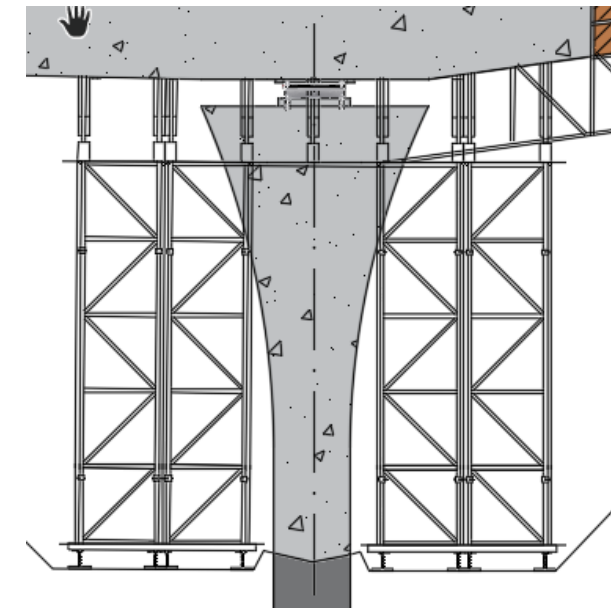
Detalle del cimbrado sobre la cimentación en el apoyo central para su construcción.
